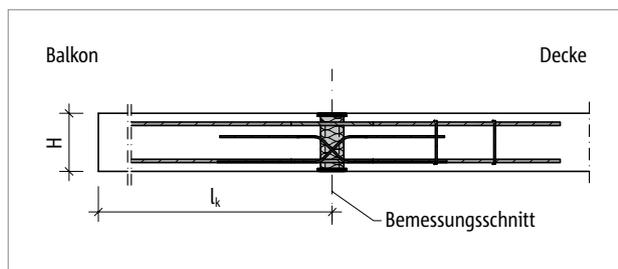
Schöck Isokorb® T Typ DP: Statisches System
